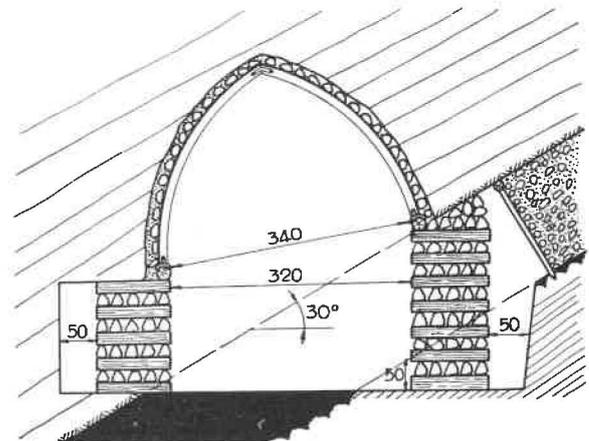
Application du soutènement articulé sur piles de bois en couches pentées.
